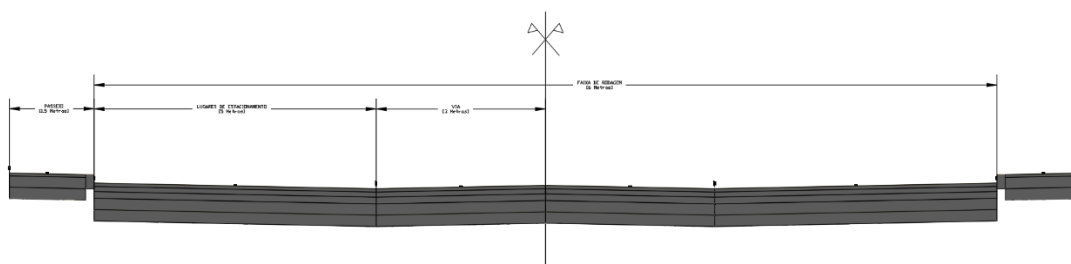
Perfil transversal tipo do projeto de loteamento com lugares de estacionamento
